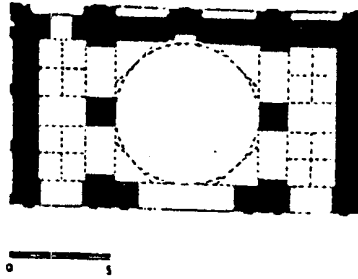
مسقط أفقى للمقبرة رقم ٤ من مقابر جبانة أسوان
